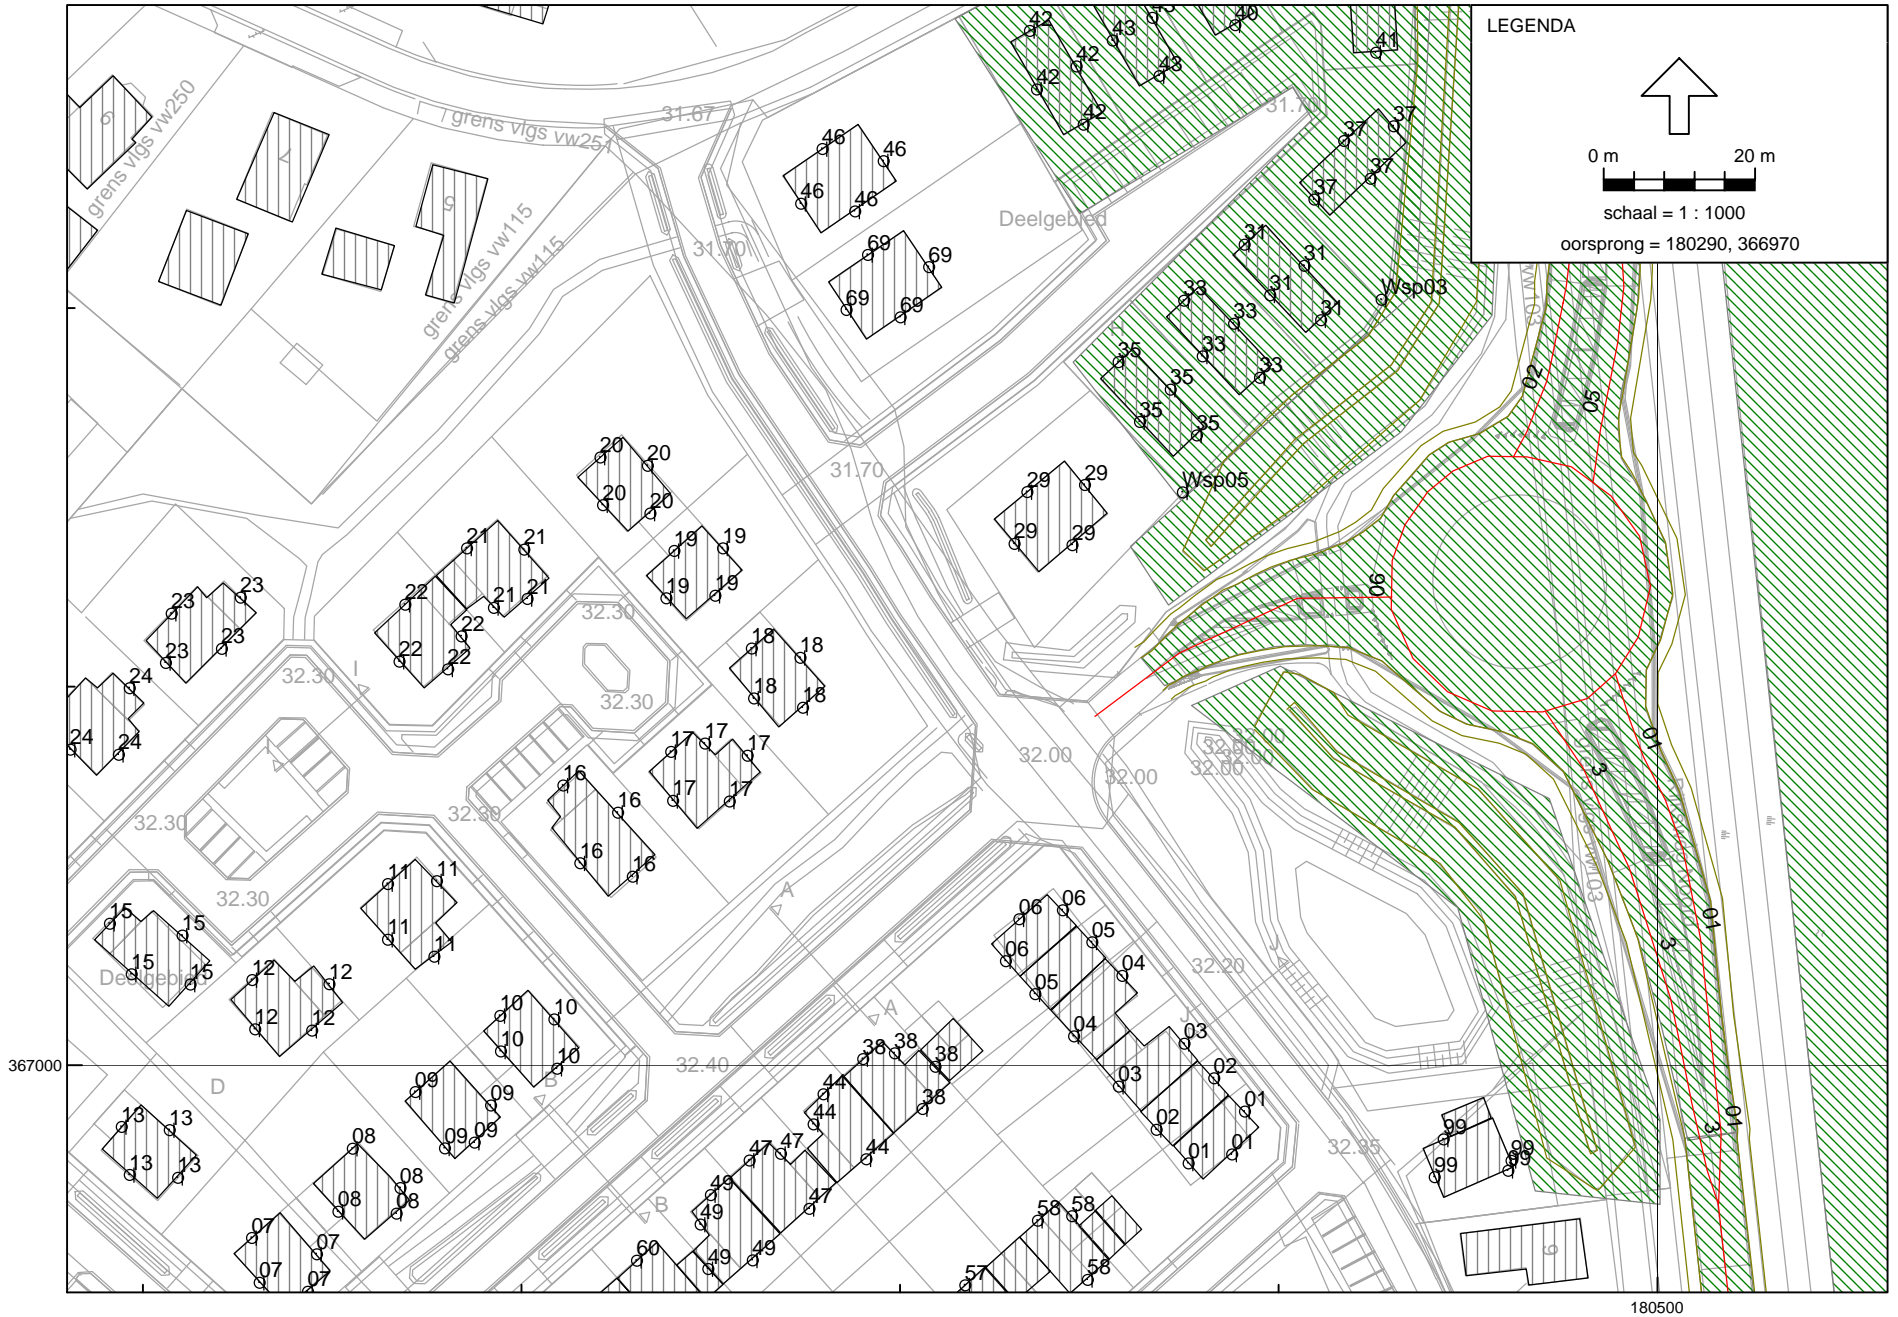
situatie rotonde in N266 met plan Hoebenakker
